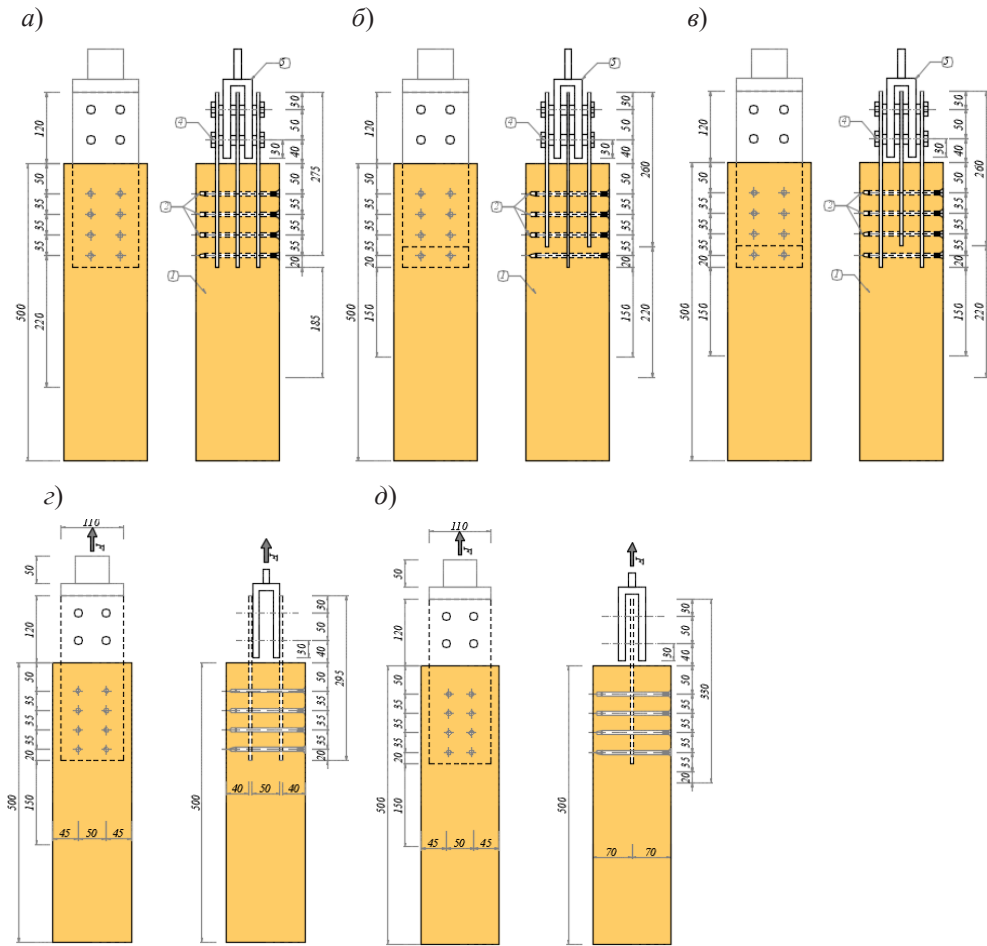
Схемы испытаний: а – схема C01^(175|175|175); б – схема C02^(140|175|140); в – схема C03^(175|140|175); г – схема C04^(175|175); д – схема C05⁽¹⁷⁵⁾
